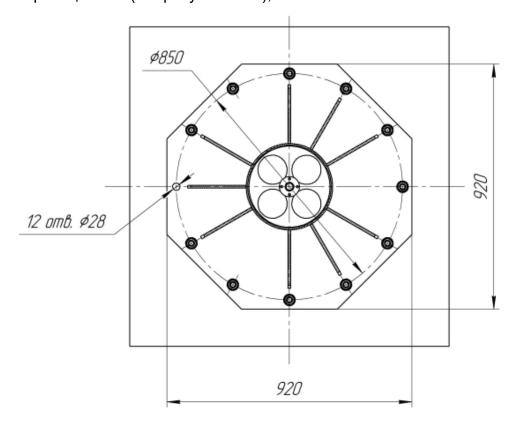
Крепление ОПУ к фундаменту/площадке
